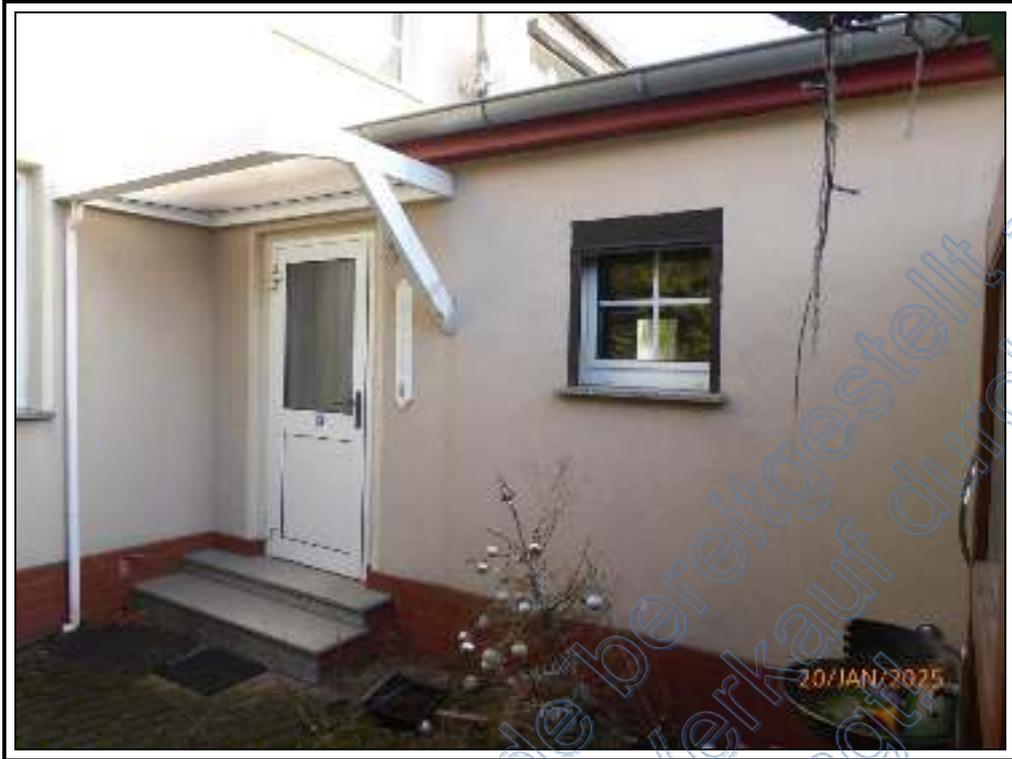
hofseitige Ansicht des Anbaus an das EFH
